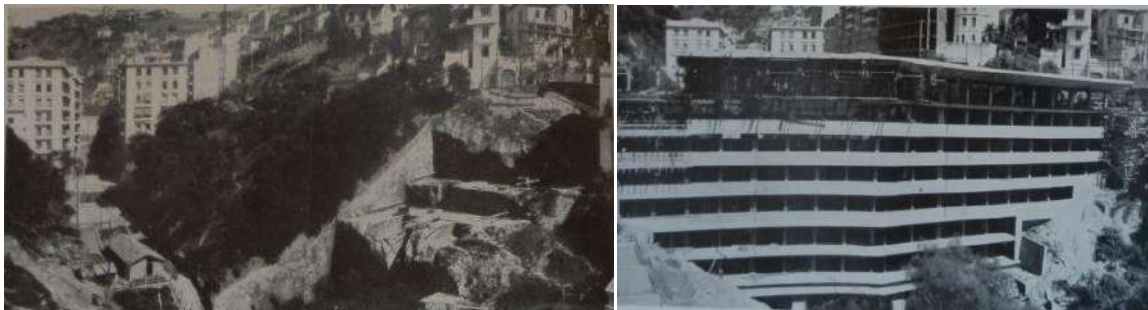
Photo du ravin avant la construction de l'immeuble pont
